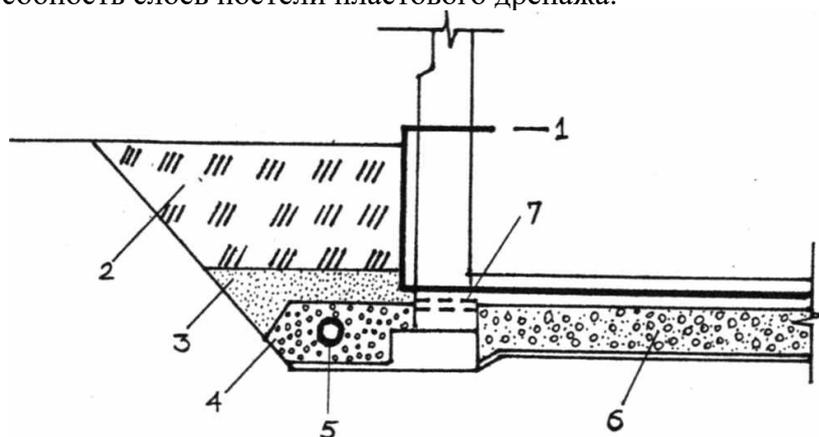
Схема конструкции пластового площадного дренажа
